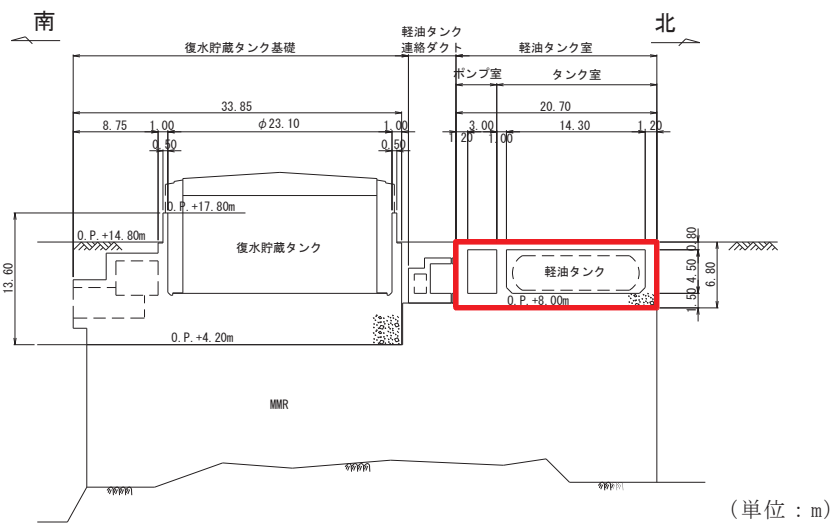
軽油タンク室断面図 (A-A 断面, 南北)
